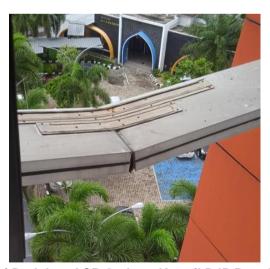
Sun Shading Gedung Kanwil DJP Bengkulu - Lampung Jatuh
